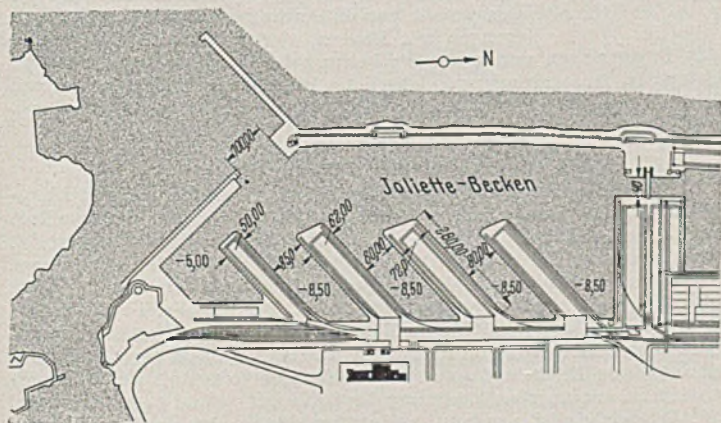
Joliette-Becken vor und nach Fertigstellung der laufenden Arbeiten.
